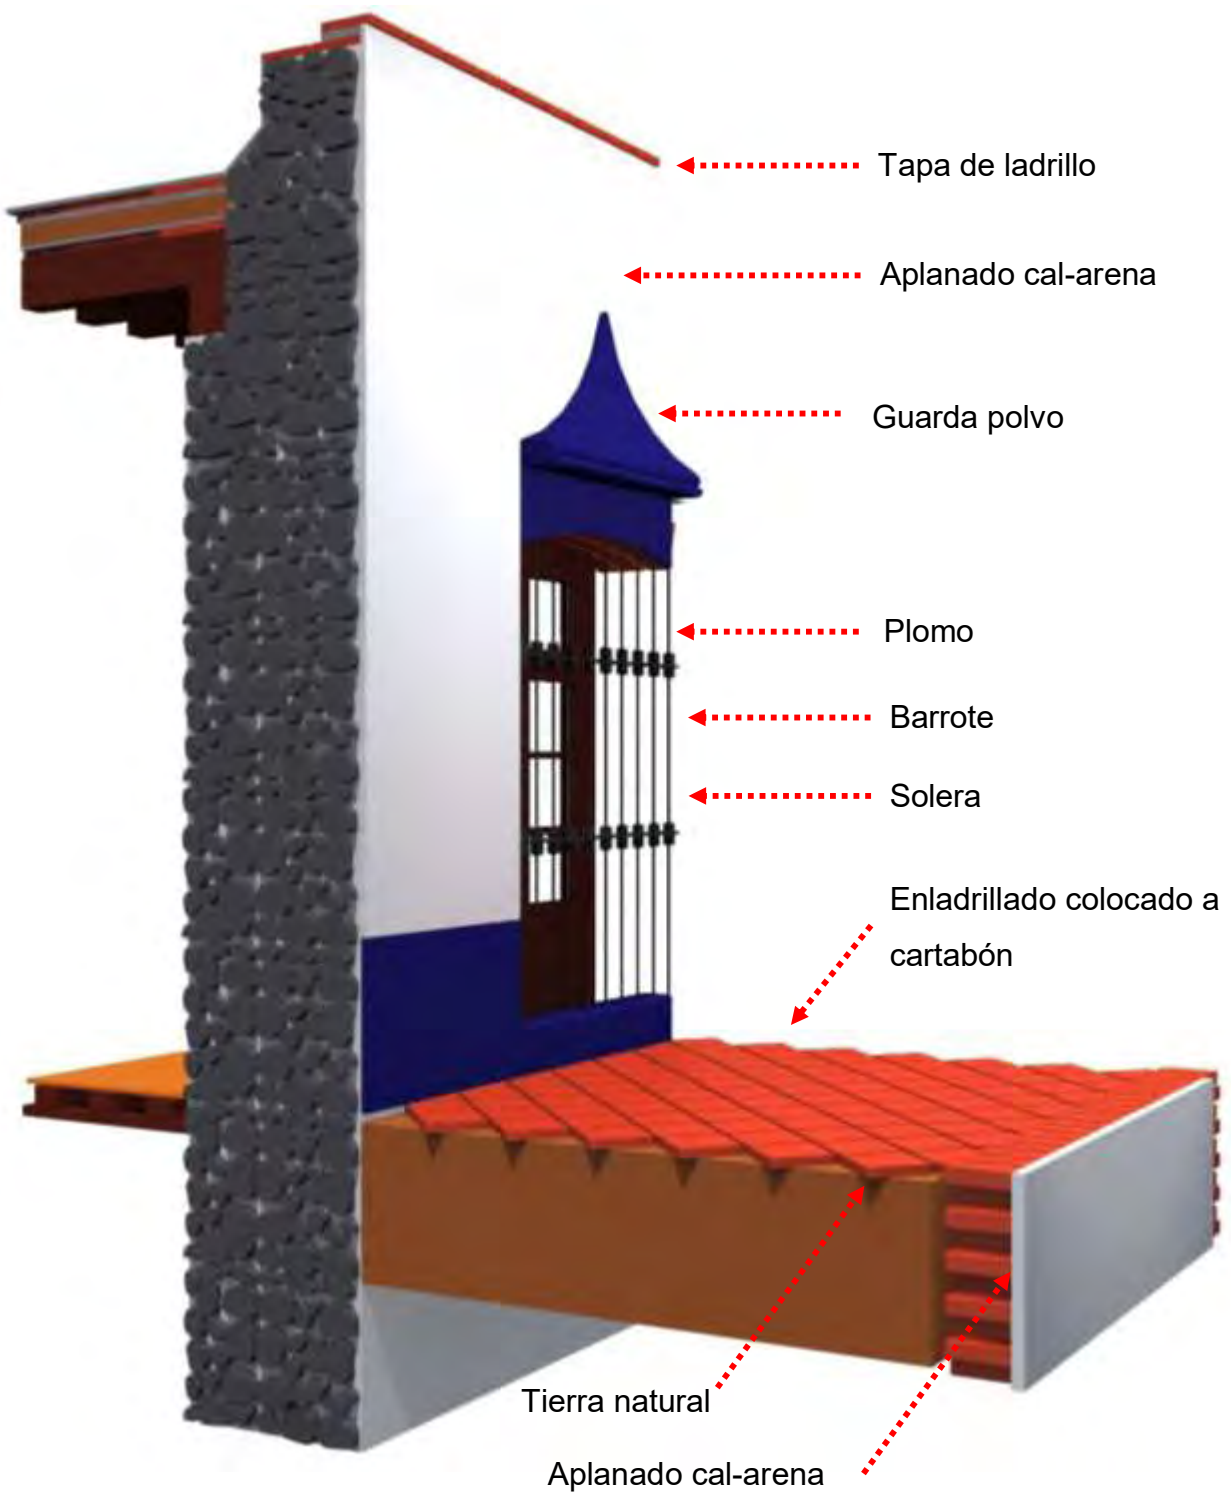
Detalle exterior del sistema constructivo de la Casa del Hacendado.
